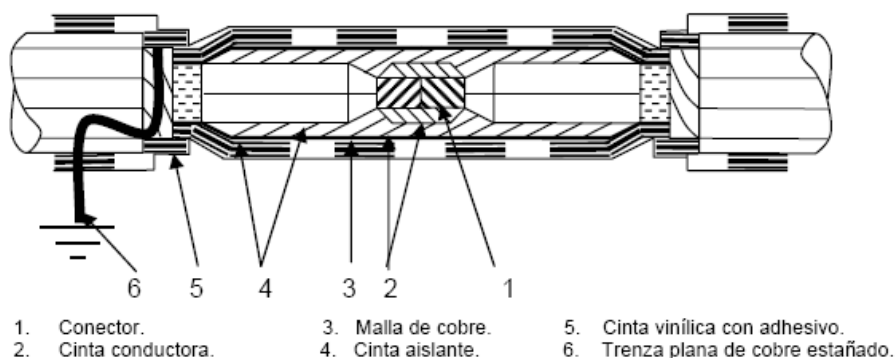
Detalles constructivos de empalmes encintados en cable monofásico con aislamiento extruido
